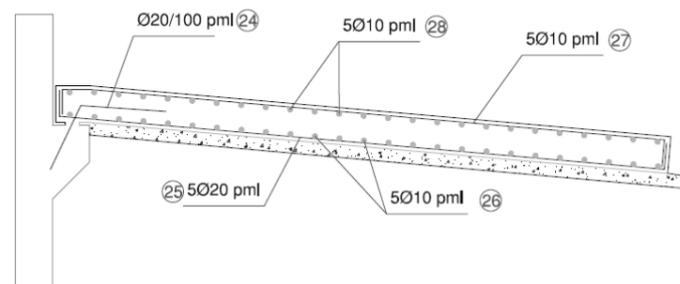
Recomendación de armado para losa de transición. Fuente: Nota de servicio sobre losas de transición en obras de paso
